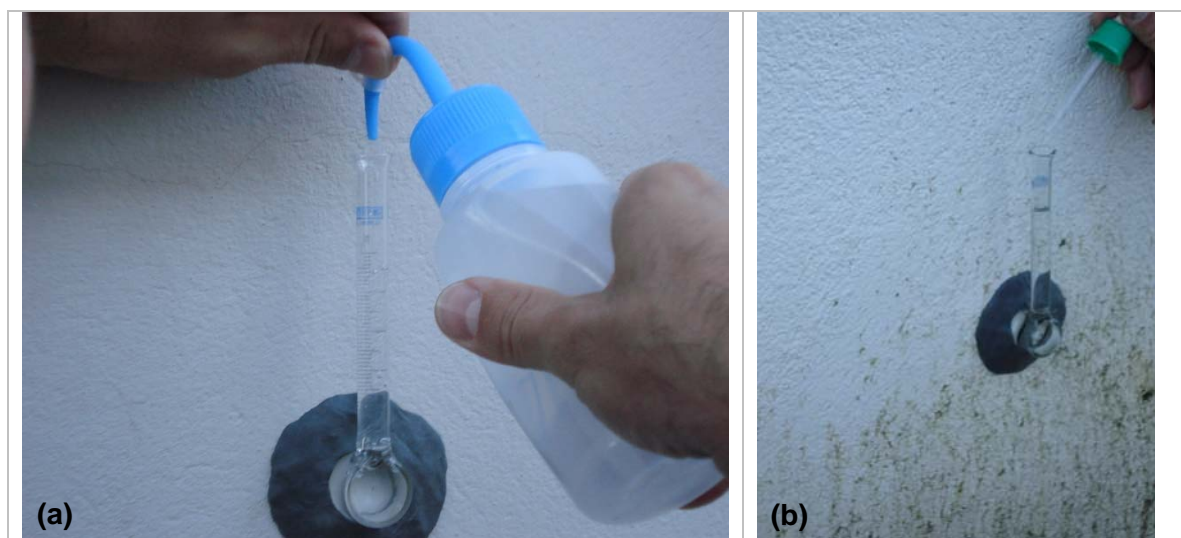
Preenchimento com água no cachimbo utilizando: pisseta (a); conta gotas (b).
